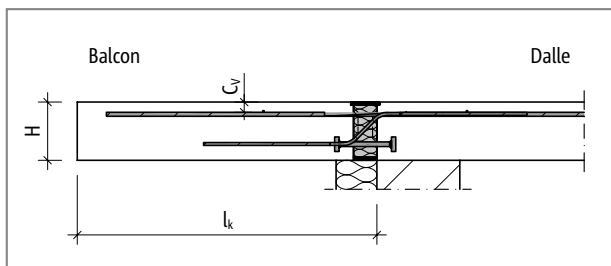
Schöck Isokorb® T Type K-M12 : Système statique
